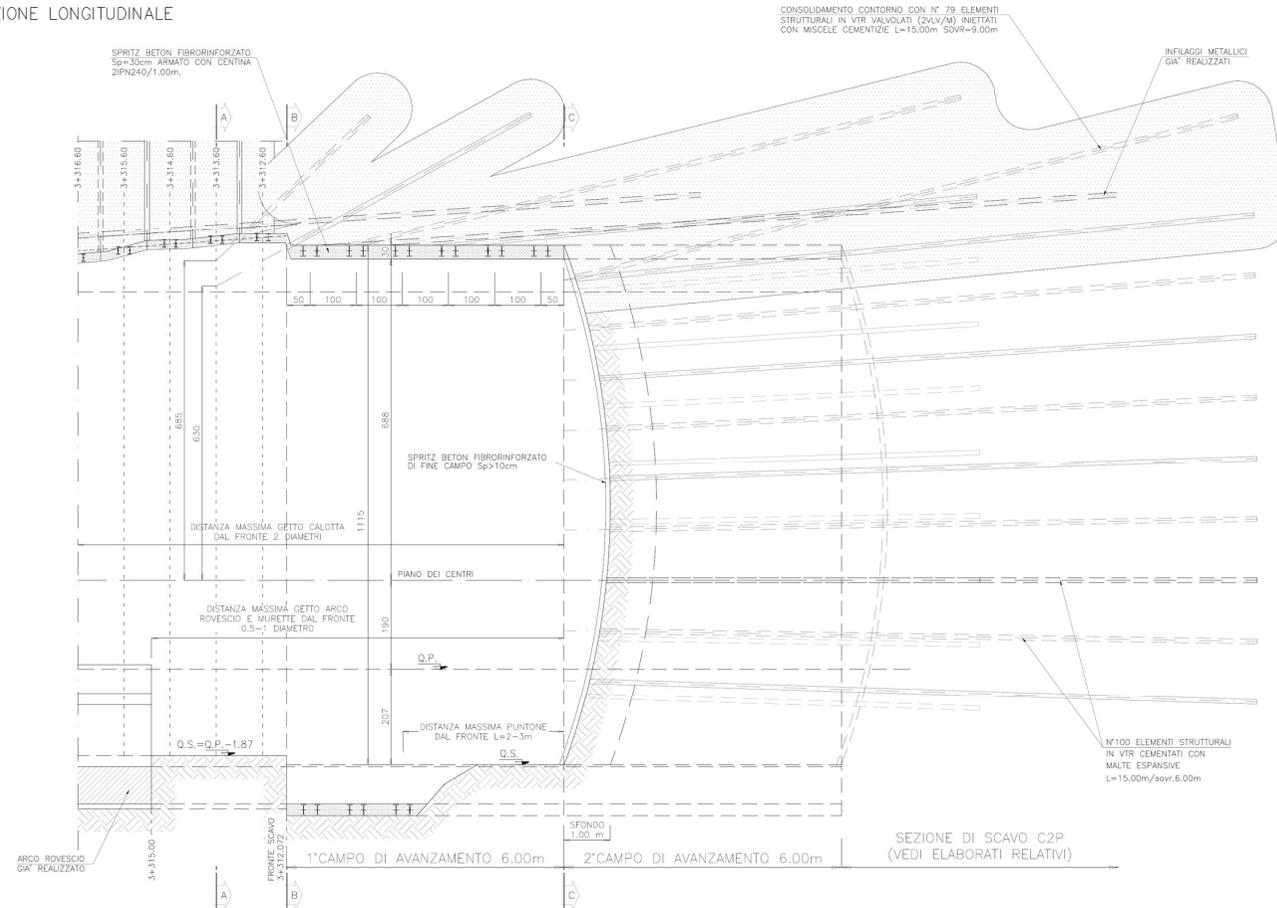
Schema consolidamenti per la ripartenza – Sezione longitudinale
